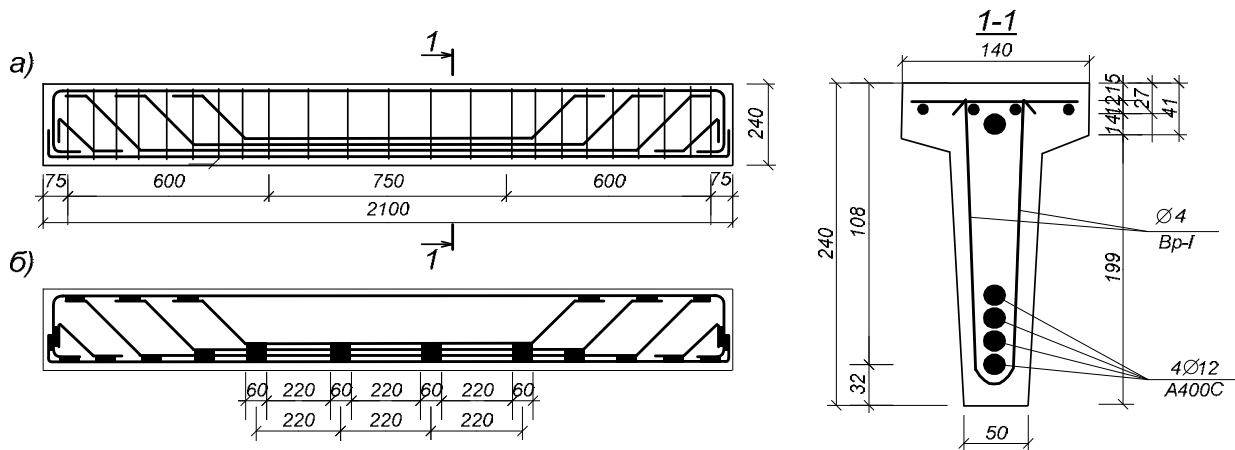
Конструкція дослідних балок (а) і зварного арматурного каркаса (б) з чотирирядним розташуванням поздовжньої арматури
